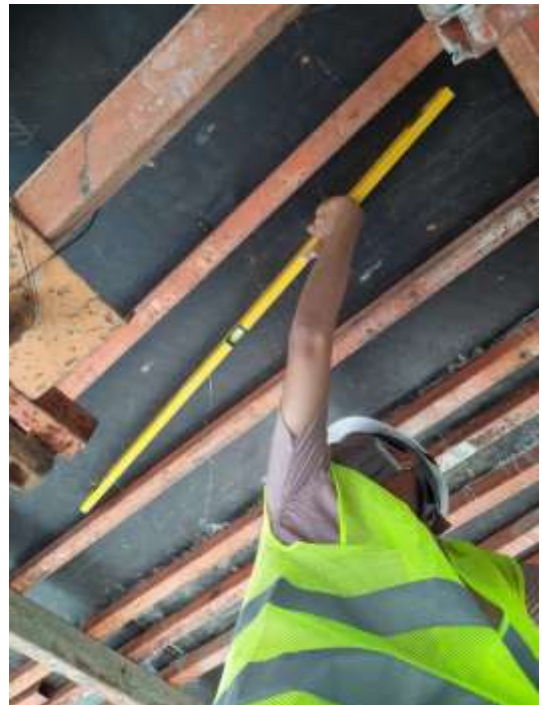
QPASS Beton Finish Balok dan Pelat
